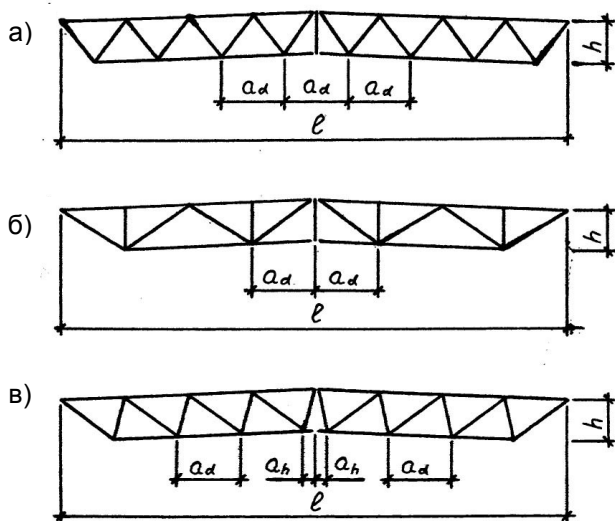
Схемы стальных ферм покрытий: а – с треугольной решеткой без дополнительных стоек; б – с треугольной решеткой с дополнительными стойками; в – с раскосной решеткой с наклонными стойками.
